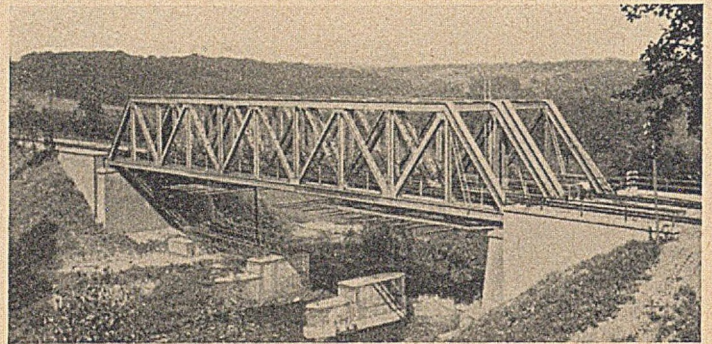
Wupperbrücke bei Leichlingen, km 15,56 der Strecke Gruiten—Köln nach endgültiger Wiederherstellung.
